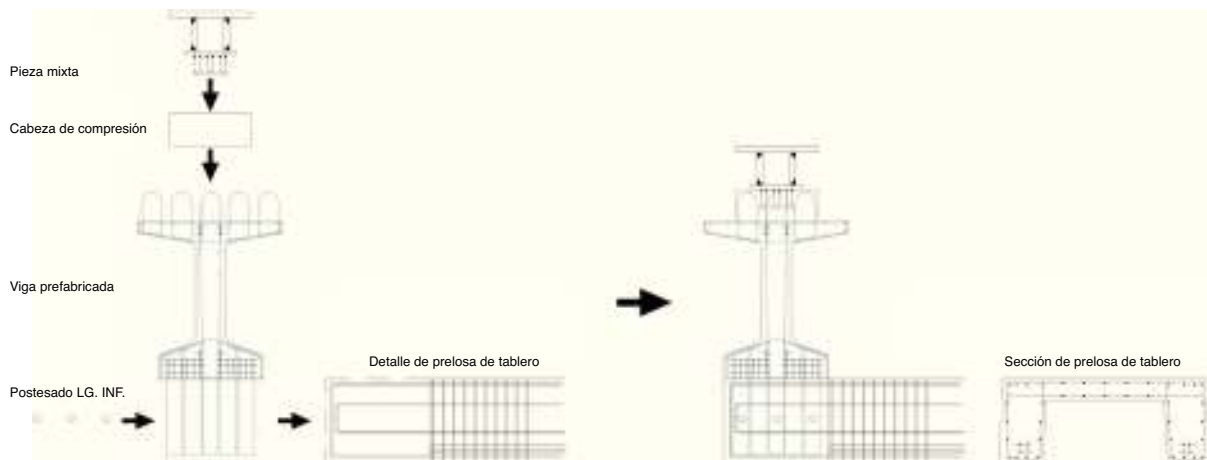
Variante solución 2 con viga longitudinal prefabricada. Sección constructiva.
